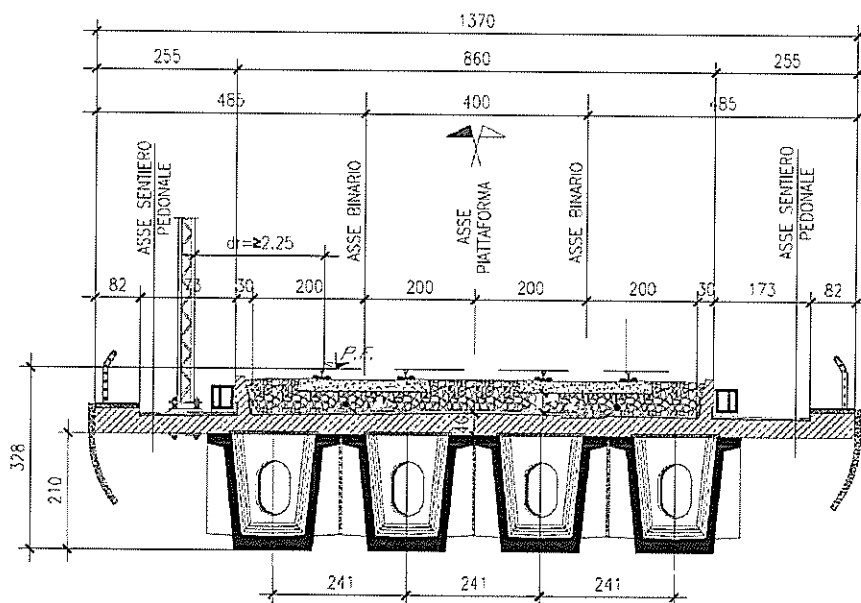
Impalcato in c.a.p.: sezione trasversale
